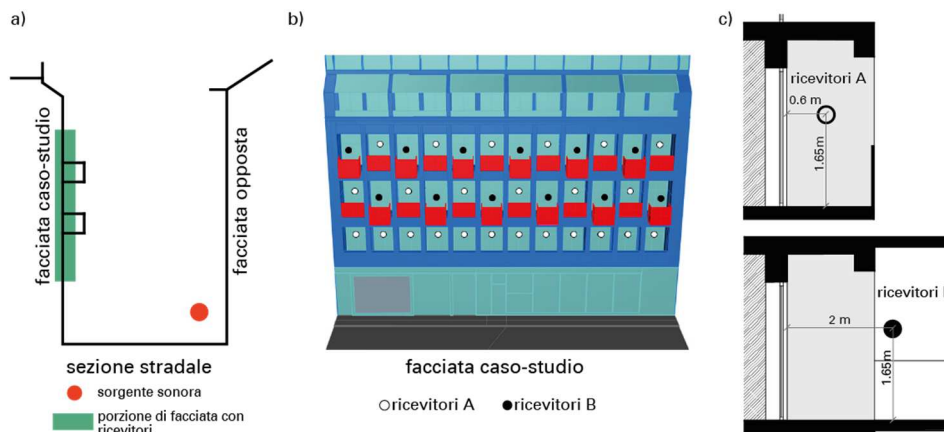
a) Sezione dello street canyon con posizione della sorgente e della facciata del caso-studio; b) facciata del caso-studio con posizione dei ricevitori A e B; c) posizione dei ricevitori A e B rispetto al filo facciata – Street section with source position and case-study façade; b) case-study facade with position of receivers A and B; c) positions of receivers A and B with respect to the facade.
